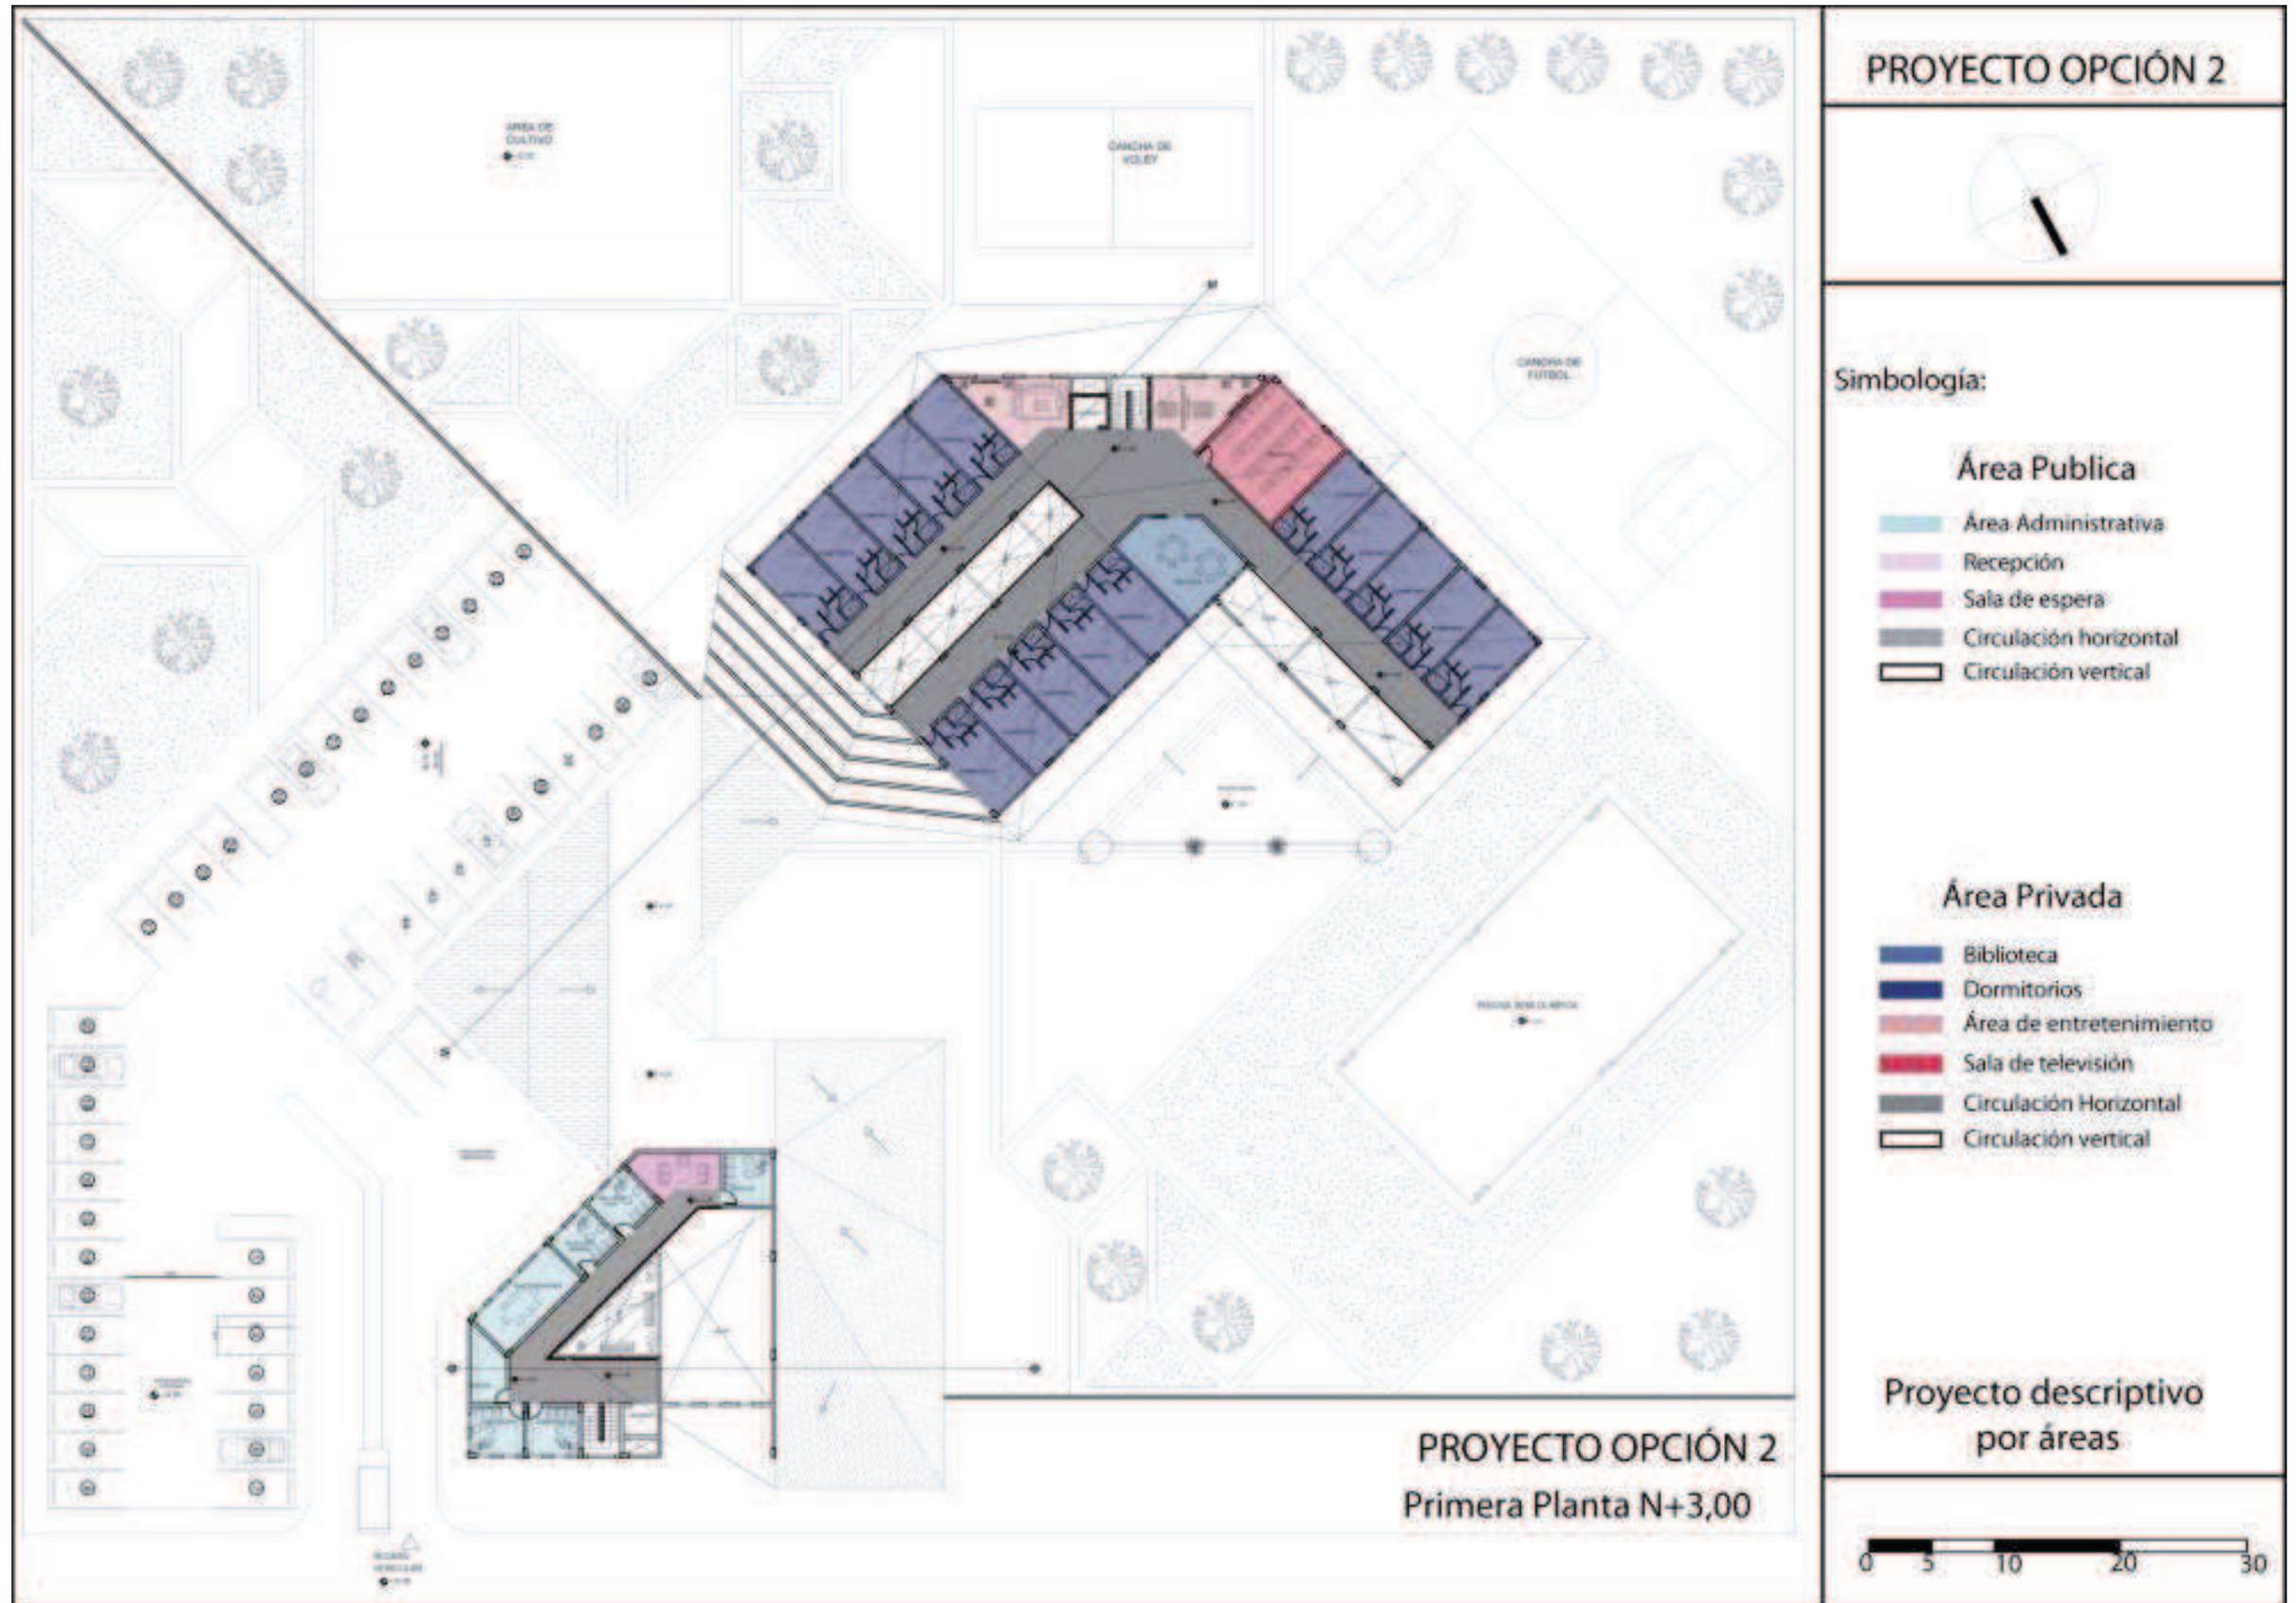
FORMA OPCIÓN 2 PRIMERA PLANTA
